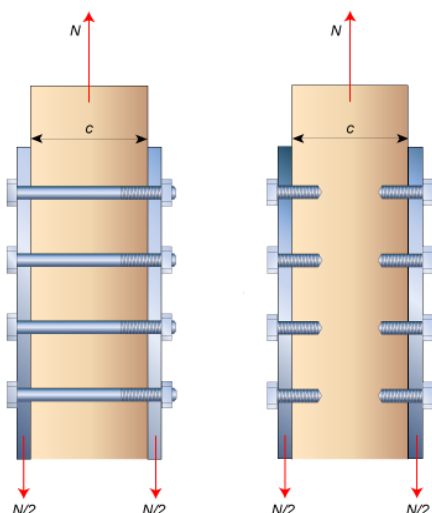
Нагельные соединения со стальными накладками на болтах и на глухих цилиндрических нагелях
